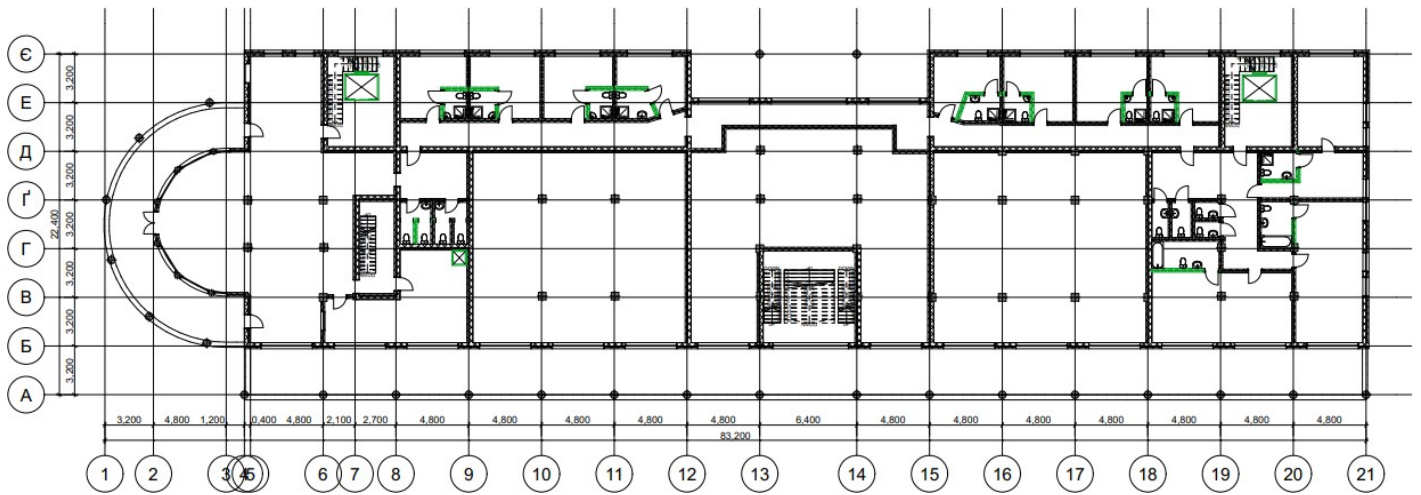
План 1 поверху з монтажем стінових конструкцій
